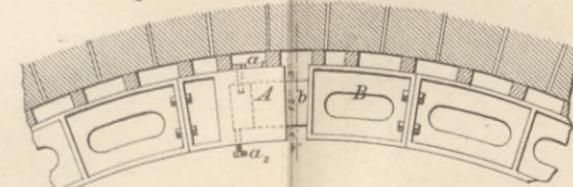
Grundriss in der Höhenlage AB.
